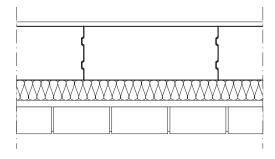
Трехслойная стена с вентилируемым зазором:
